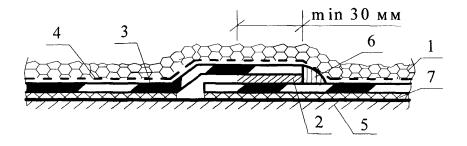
Стык смежных полотнищ плёнки с пригрузом 1—пригруз; 2—сварка; 3— "ROCKmembrane"; 4—геотекстиль (защитный синтетический или стекловолокнистый материал); 5—основание под кровлю; 6—ПВХ—масса после прикатки шва; 7—защитный синтетический материал (геотекстиль).
